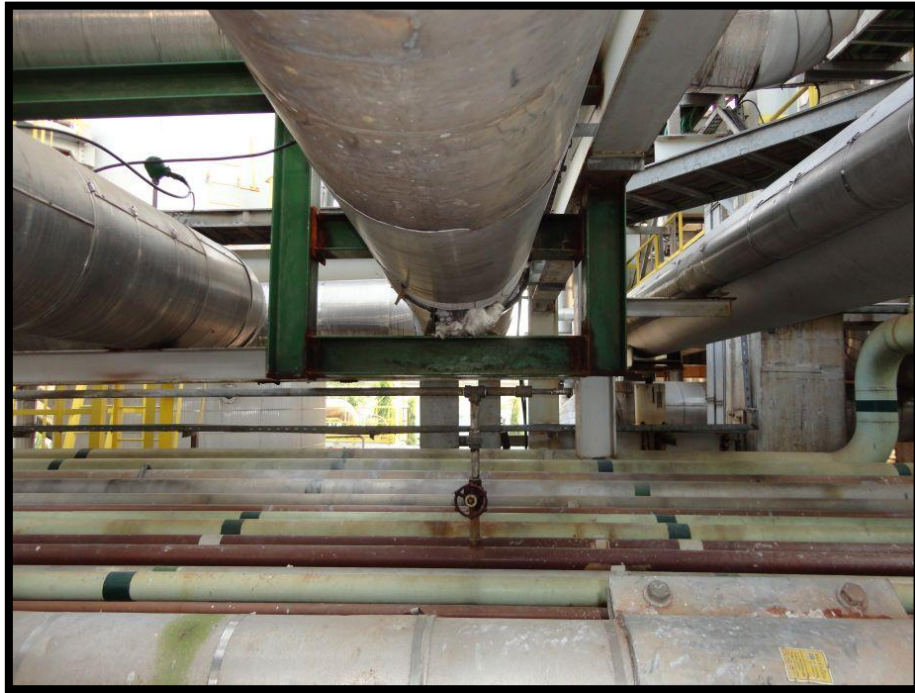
Clem Support* Berdasarkan Lapangan
